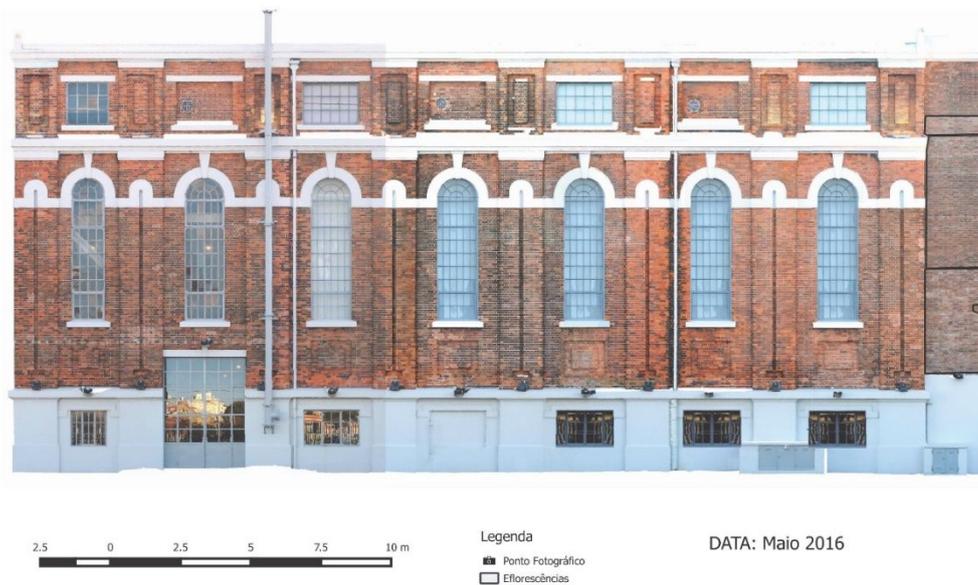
Distribuição de eflorescências detetadas na Fachada Norte do Edifício de Baixa Pressão
